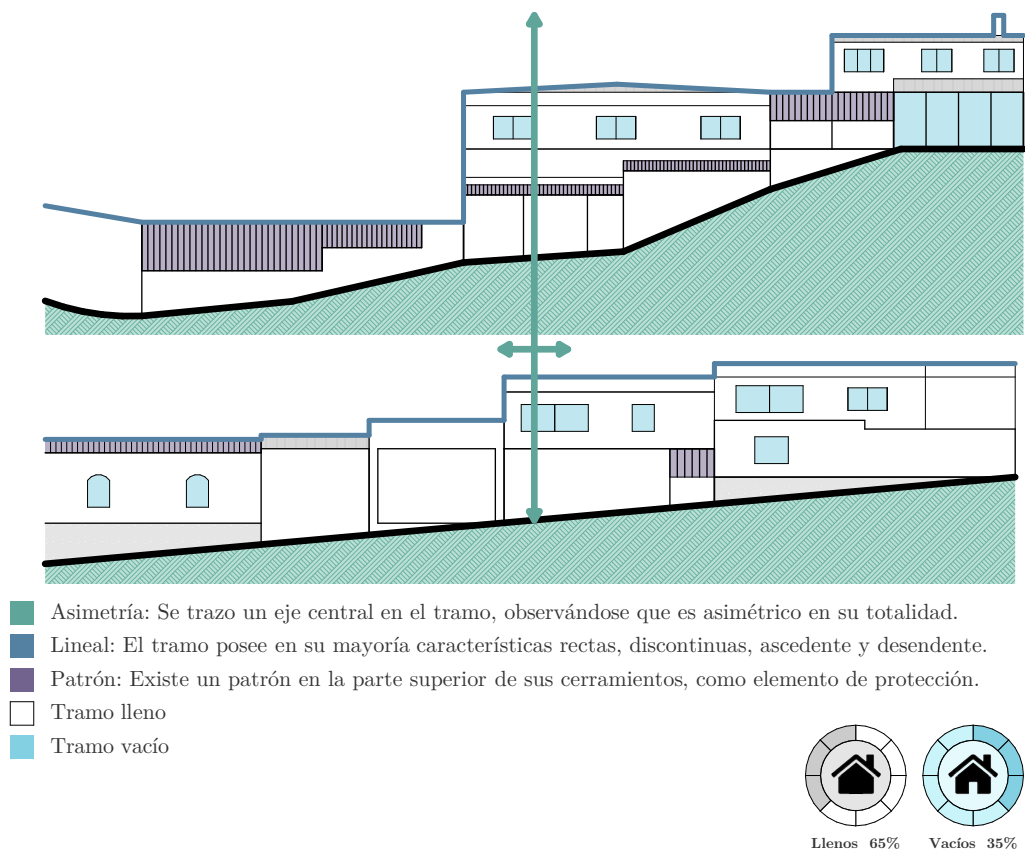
Esquema tramo Calle Iván Orozco. Elaborado: Autores.
